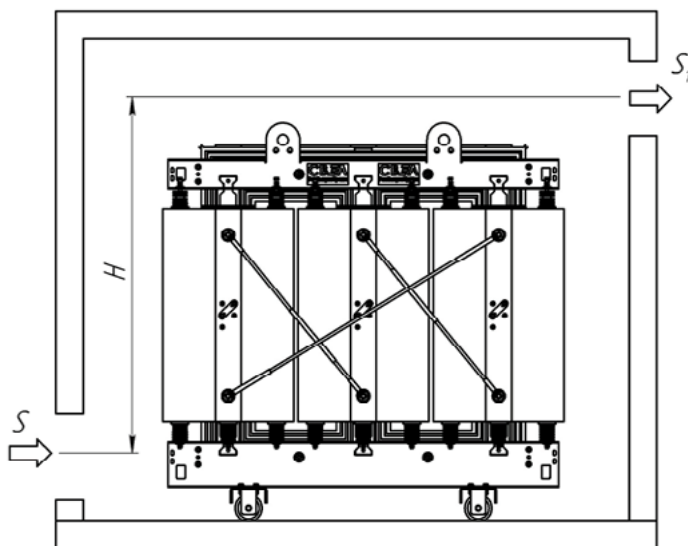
Пояснительный эскиз для расчета системы вентиляции
